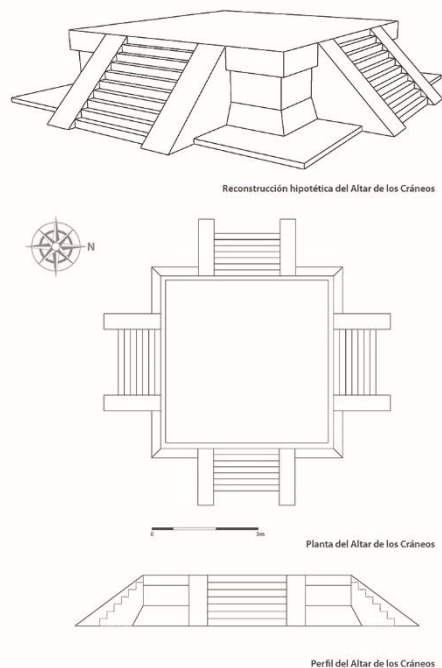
Perspectiva, planta y perfil de reconstrucción hipotética del Altar de los Cráneos. Dibujo Adrián Colchado, INAH, 2011.
